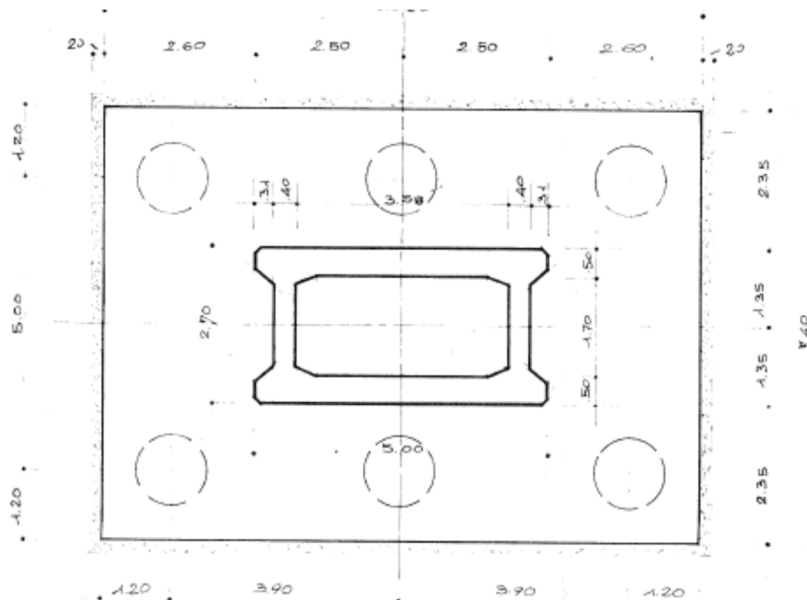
Pianta della fondazione su dei pali, 6 pali
